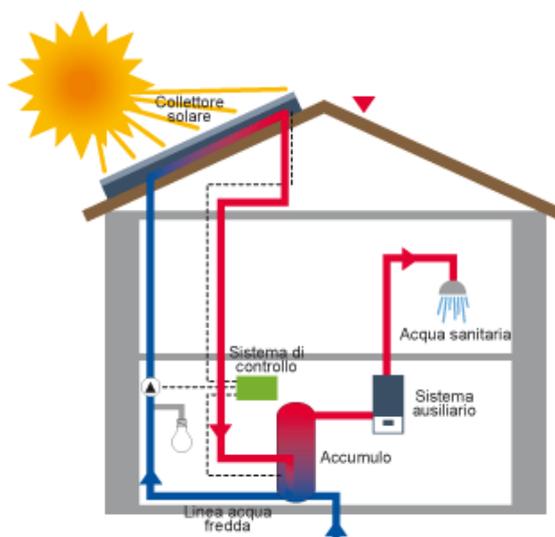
Schema di un impianto solare a circolazione forzata
